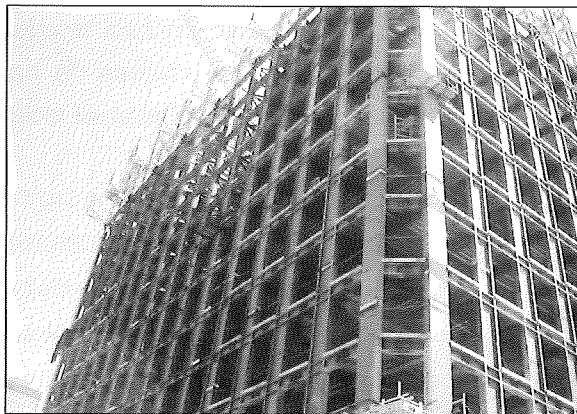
VISTA DE LA ESTRUCTURA DE LA FACHADA DE TORRE PICASSO
